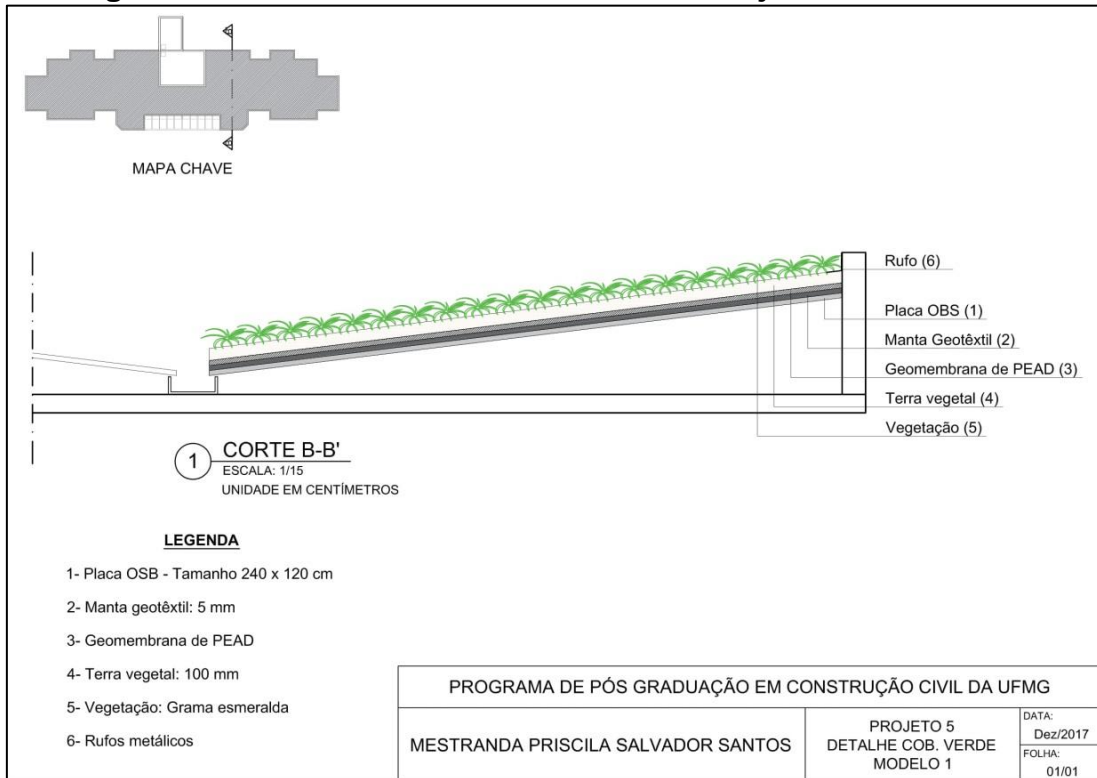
Detalhe Cobertura Verde do Projeto 4 do Modelo 1
